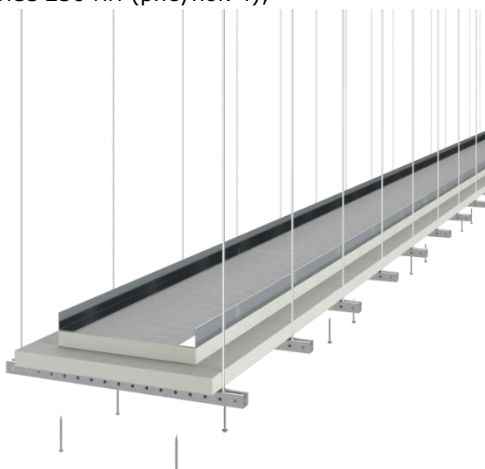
Установка монтажного уголка DG3030 или DG6060 при помощи саморезов
